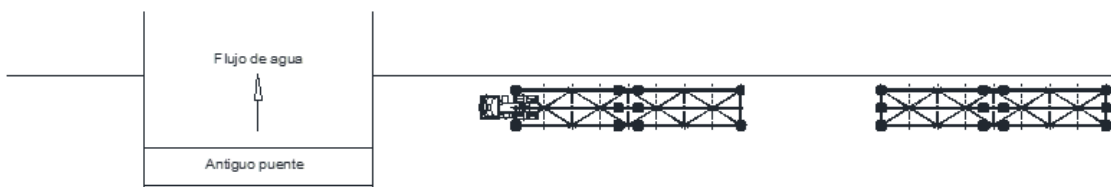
Descenso de las primeras 3 vigas en el dolly mediante cilindros hidráulicos
